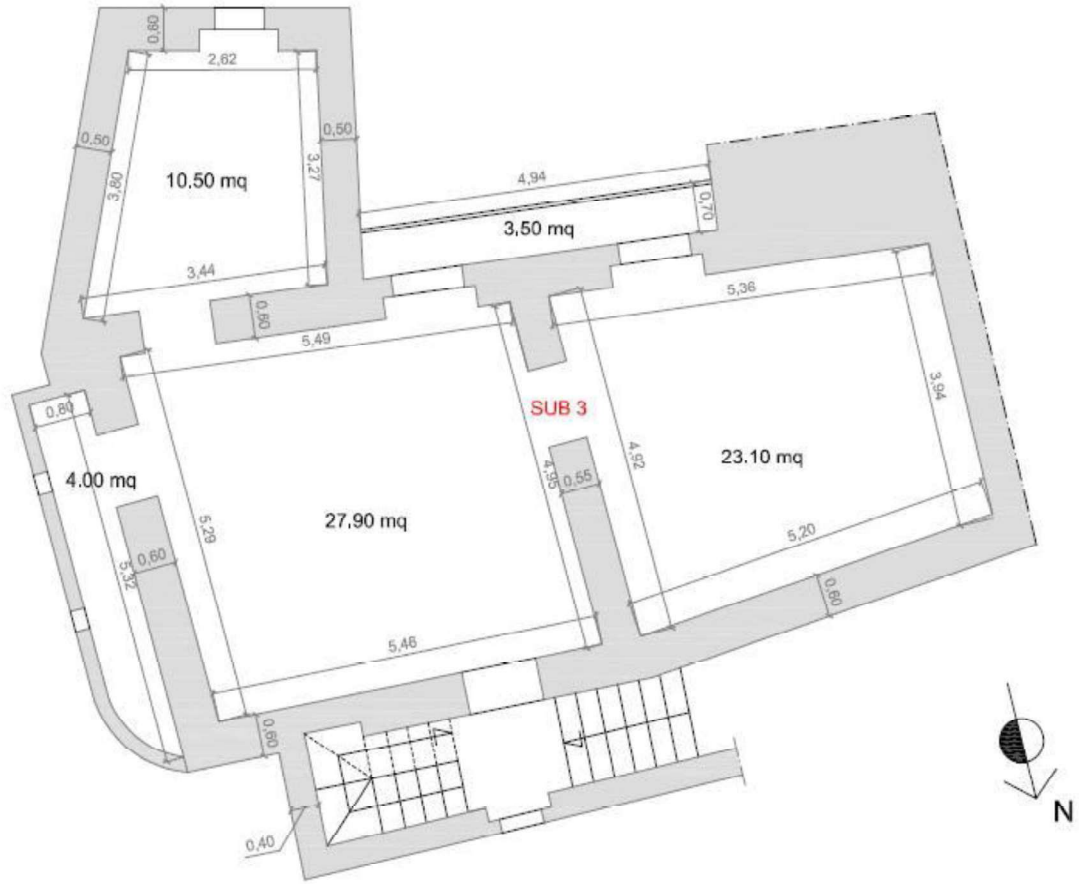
Planimetria Catastale Immobile, Piano 1, Foglio 35, p.la 817, Sub 3.
